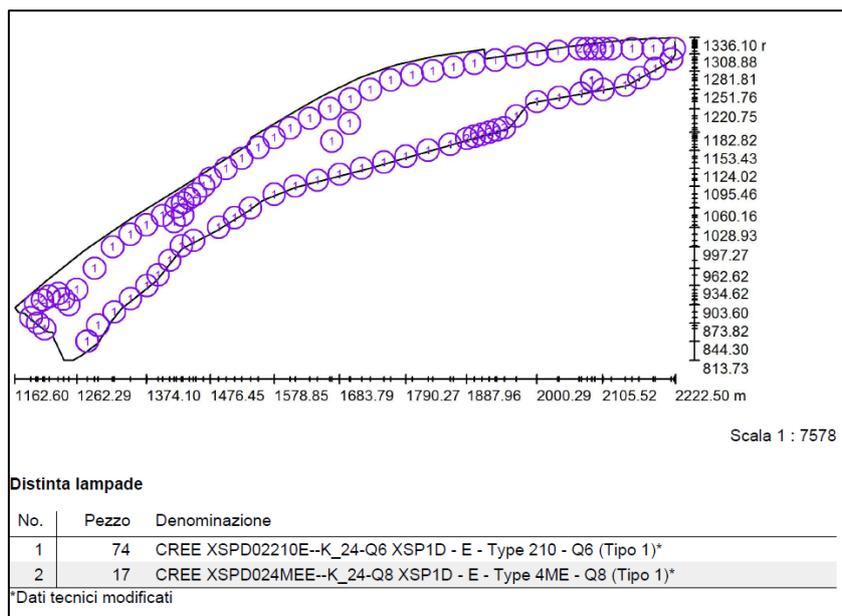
Ubicazione e tipologia dei corpi illuminanti previsti – area di cantiere di Salbertrand
